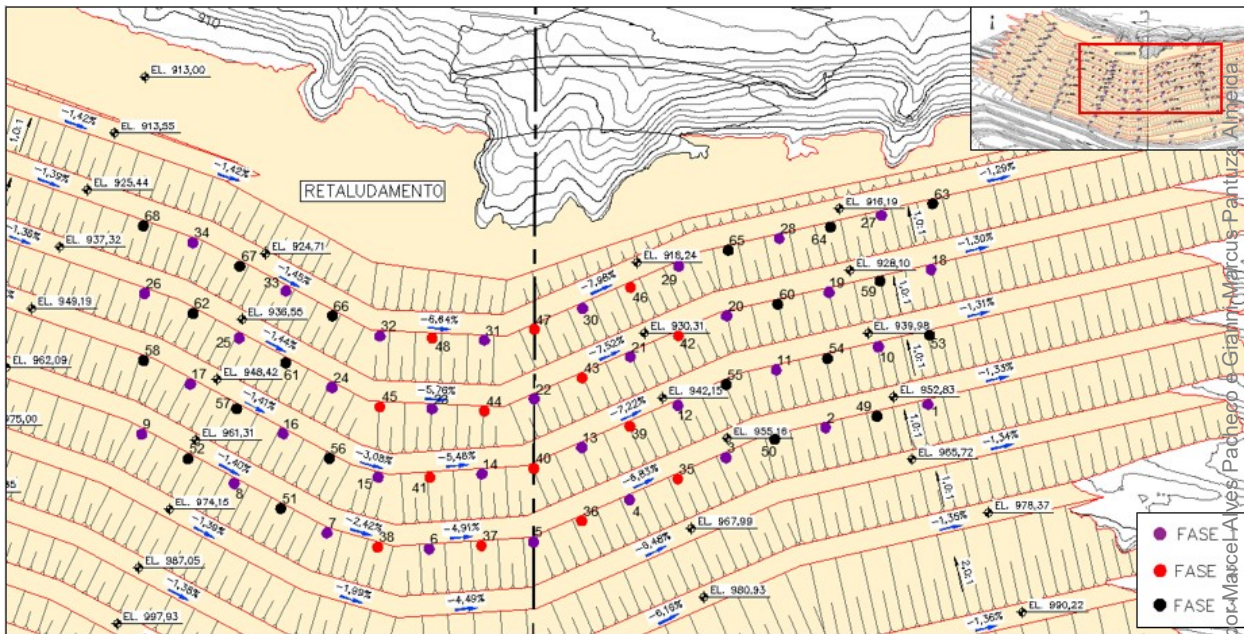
Disposição dos DHPs em planta (1190DD-X-17208)
